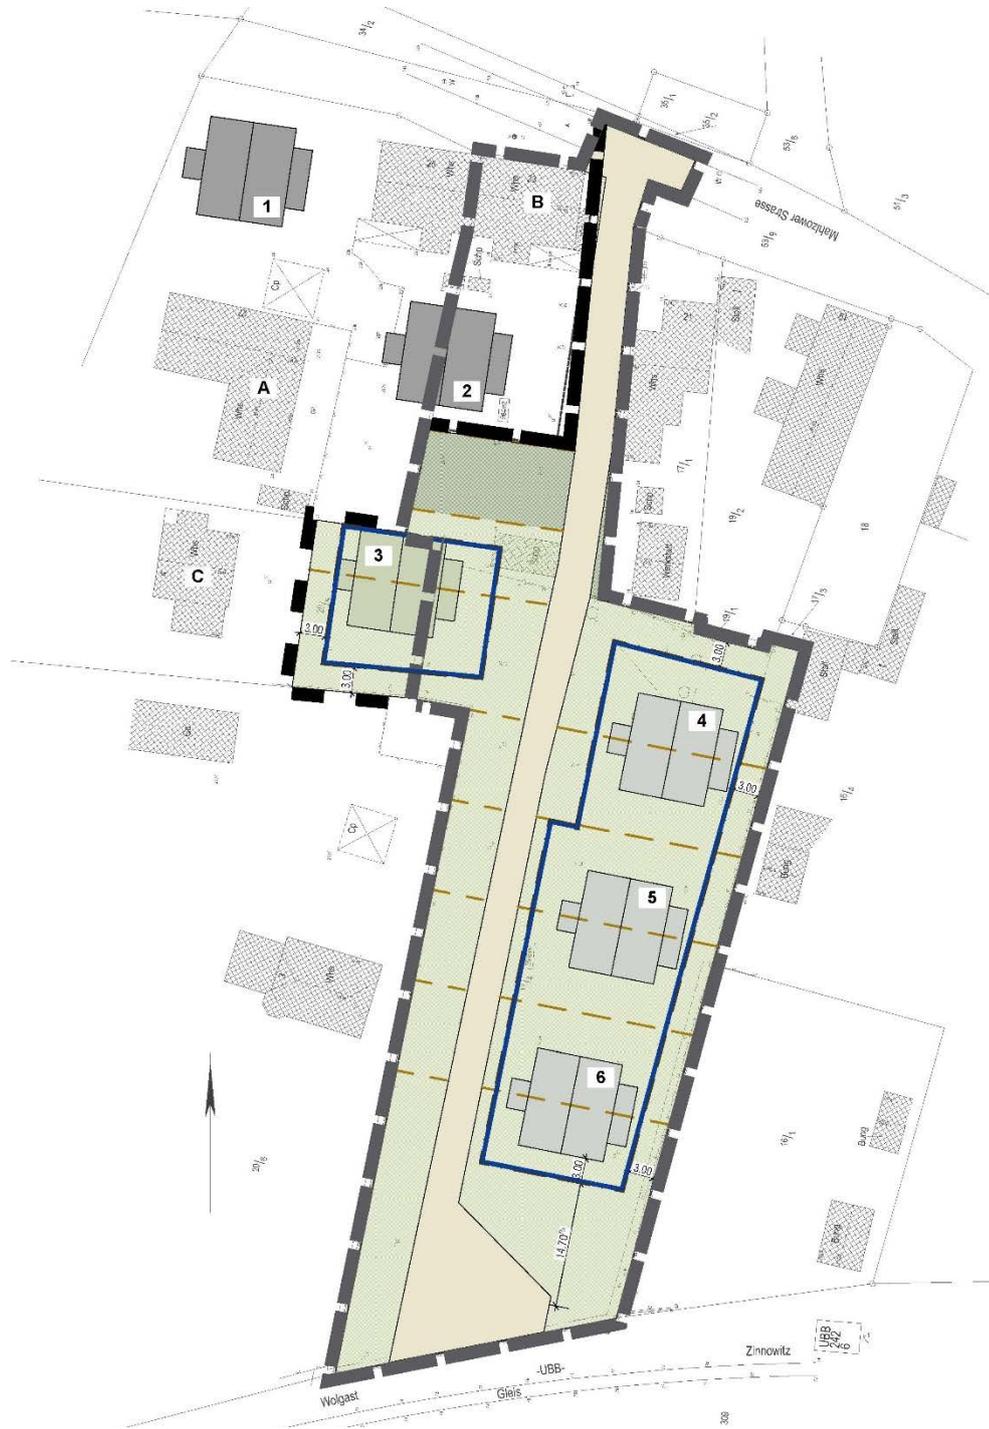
Städtebauliches Konzept - Vorentwurf (Grundlage: Lageentwurf Architektur- und Ingenieurbüro Arlt, Dresden, 12 - .2021)
